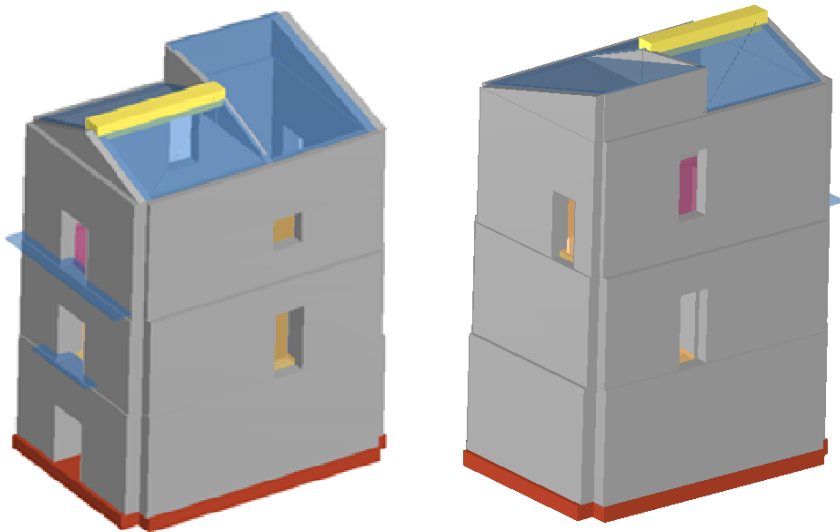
edificio 3D, prospetto Nord-Est e Sud-Ovest
